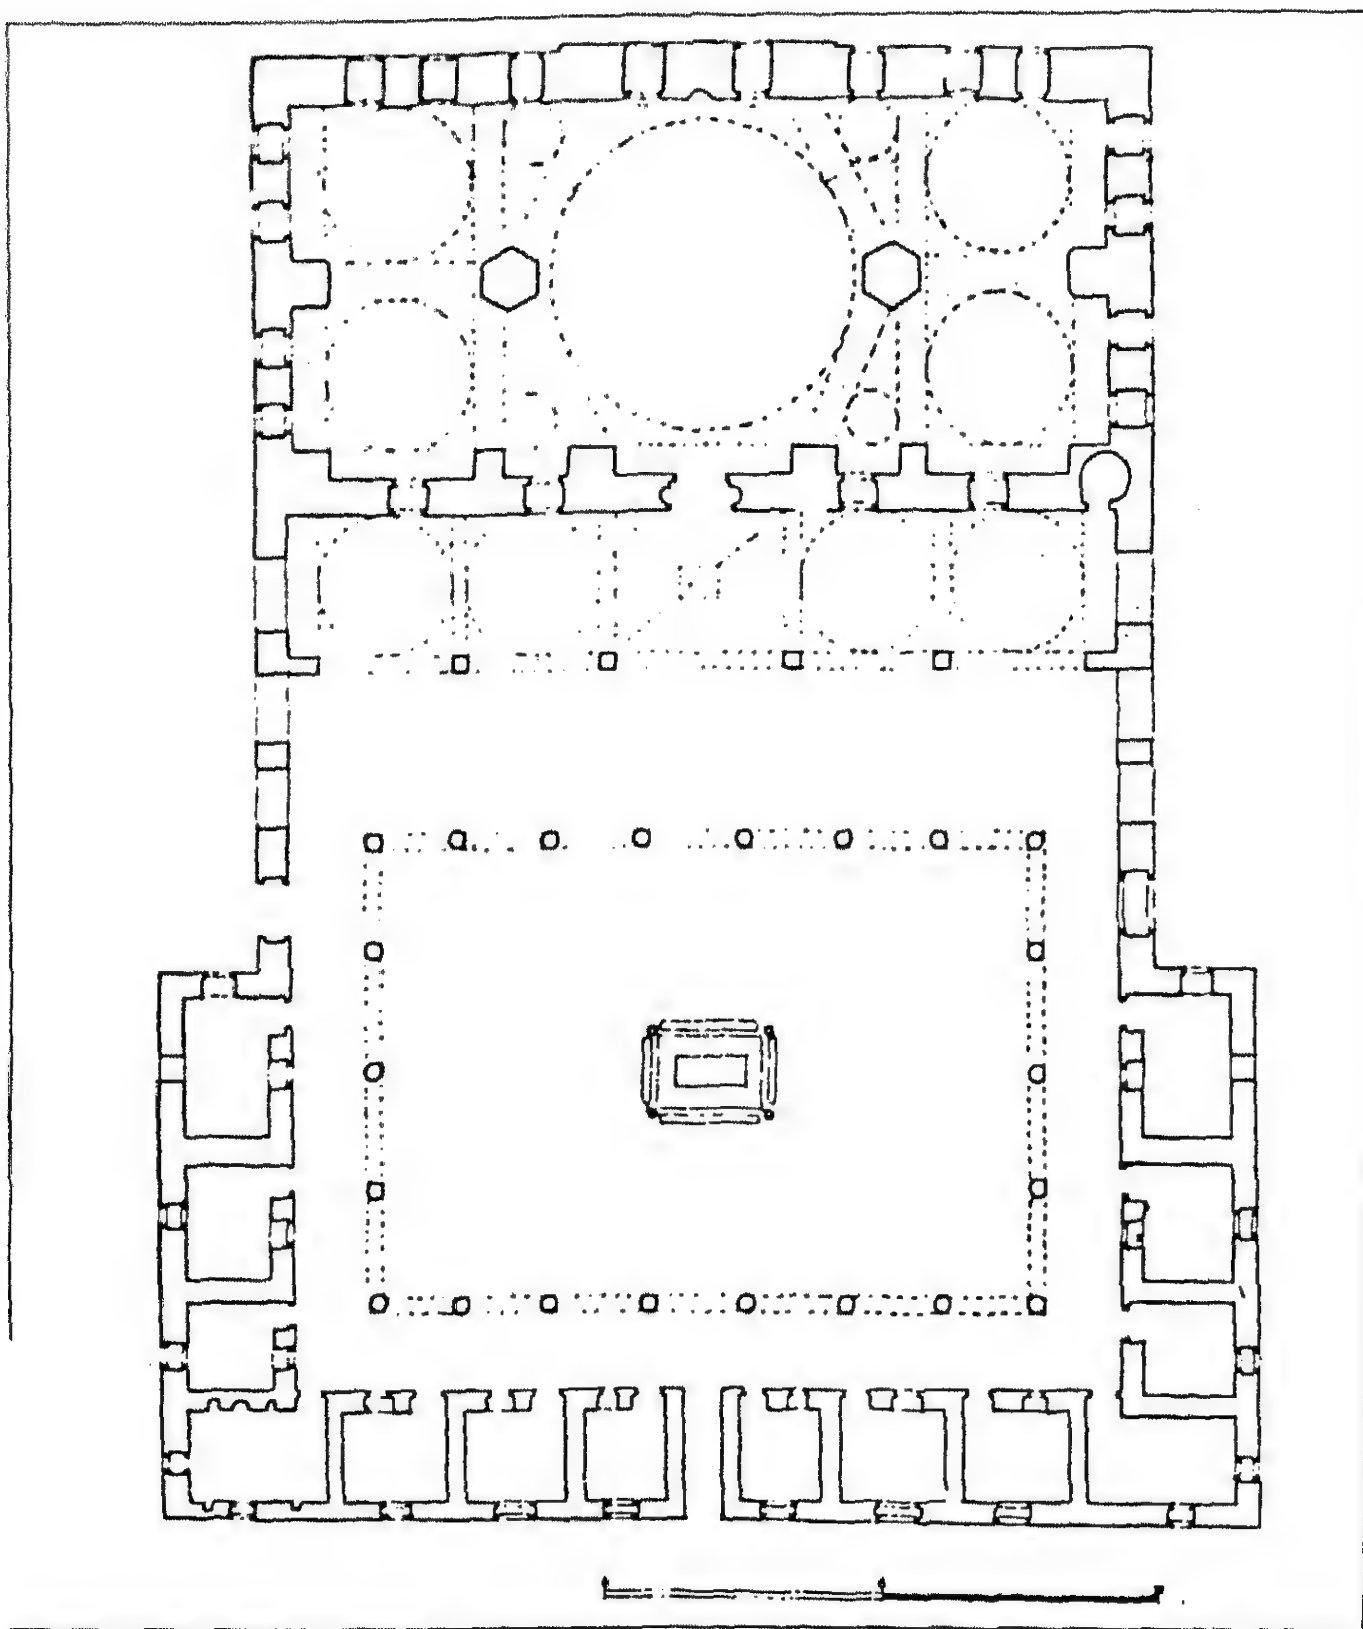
مسقط أفقي لمسجد قيرشنلو محمد باشا في شقودر بألبانيا (عن : كيل) .
